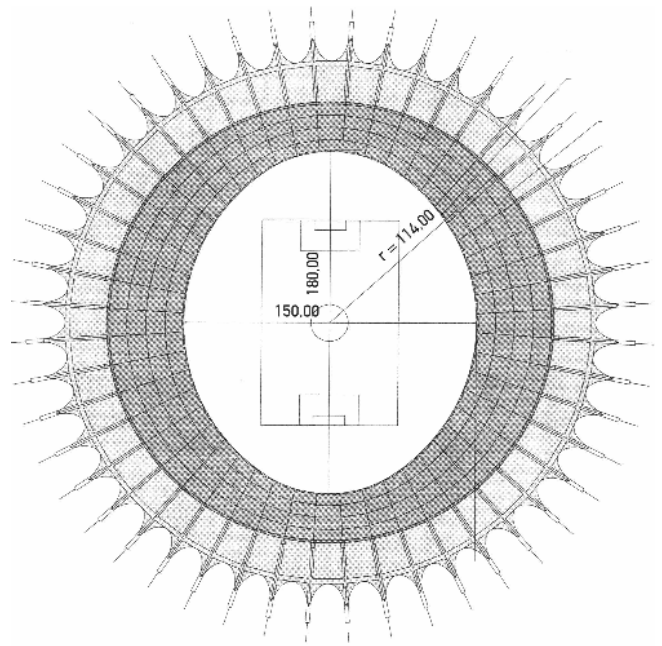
Grundriss und Schnitt des Pusan Dome; aus /3/
